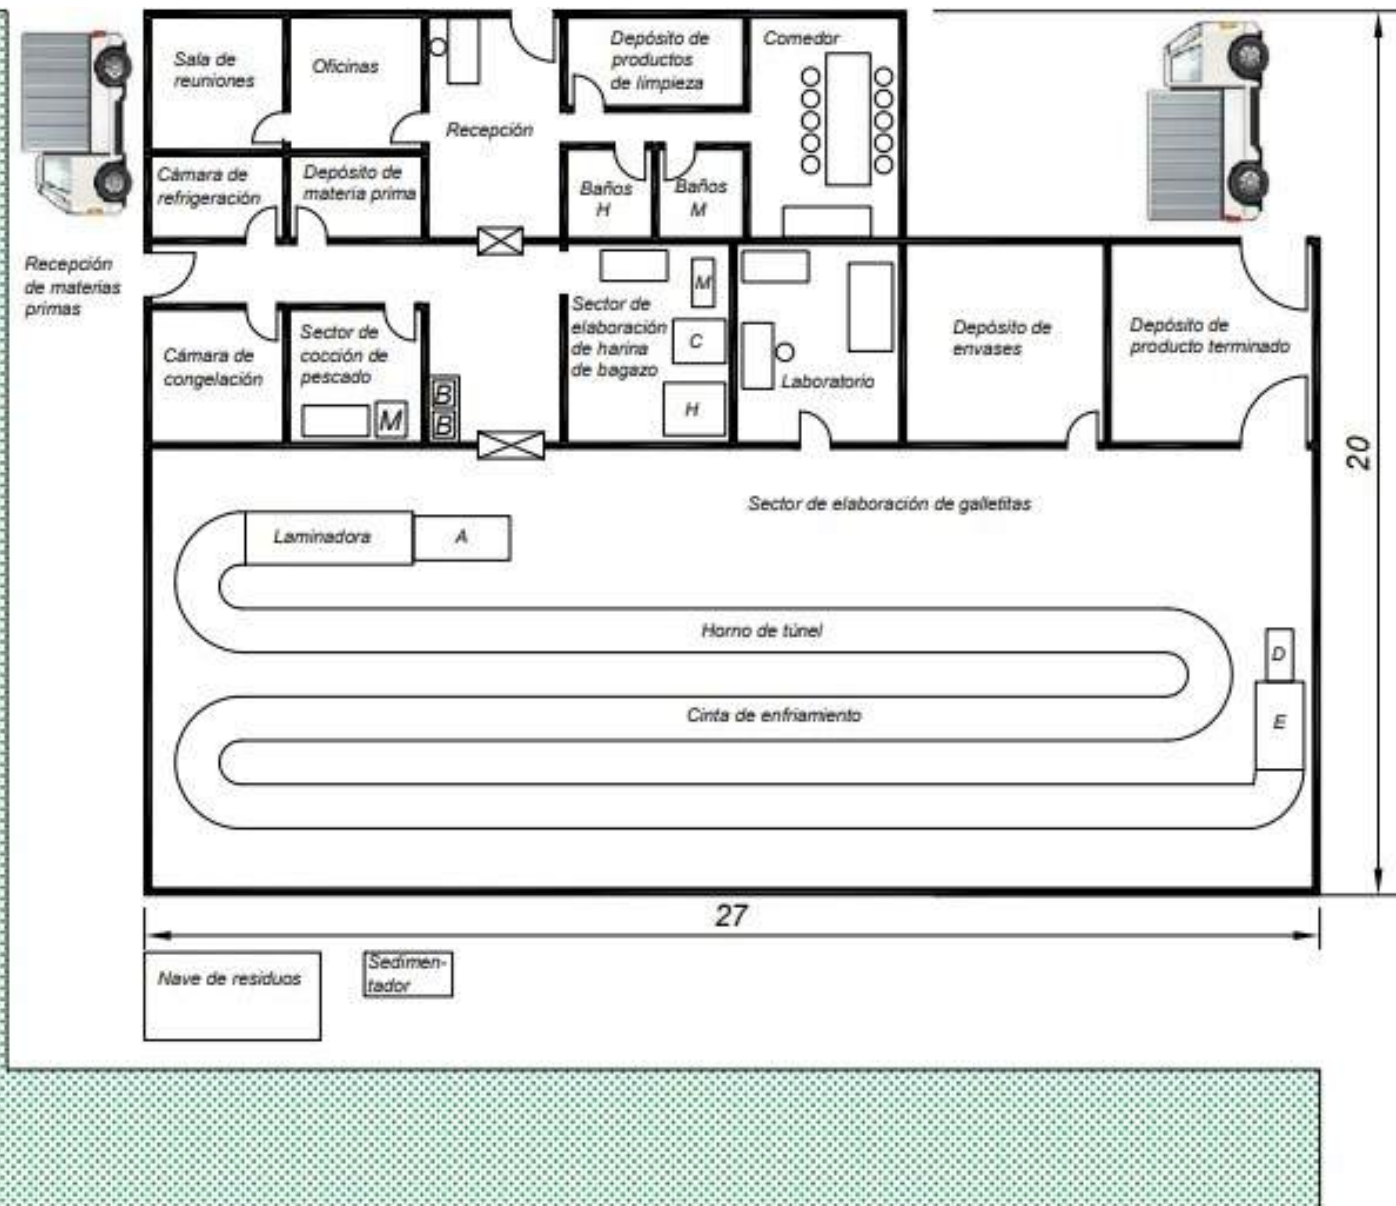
Lay out de planta elaboradora de galletas de pescado y harina de bagazo.
